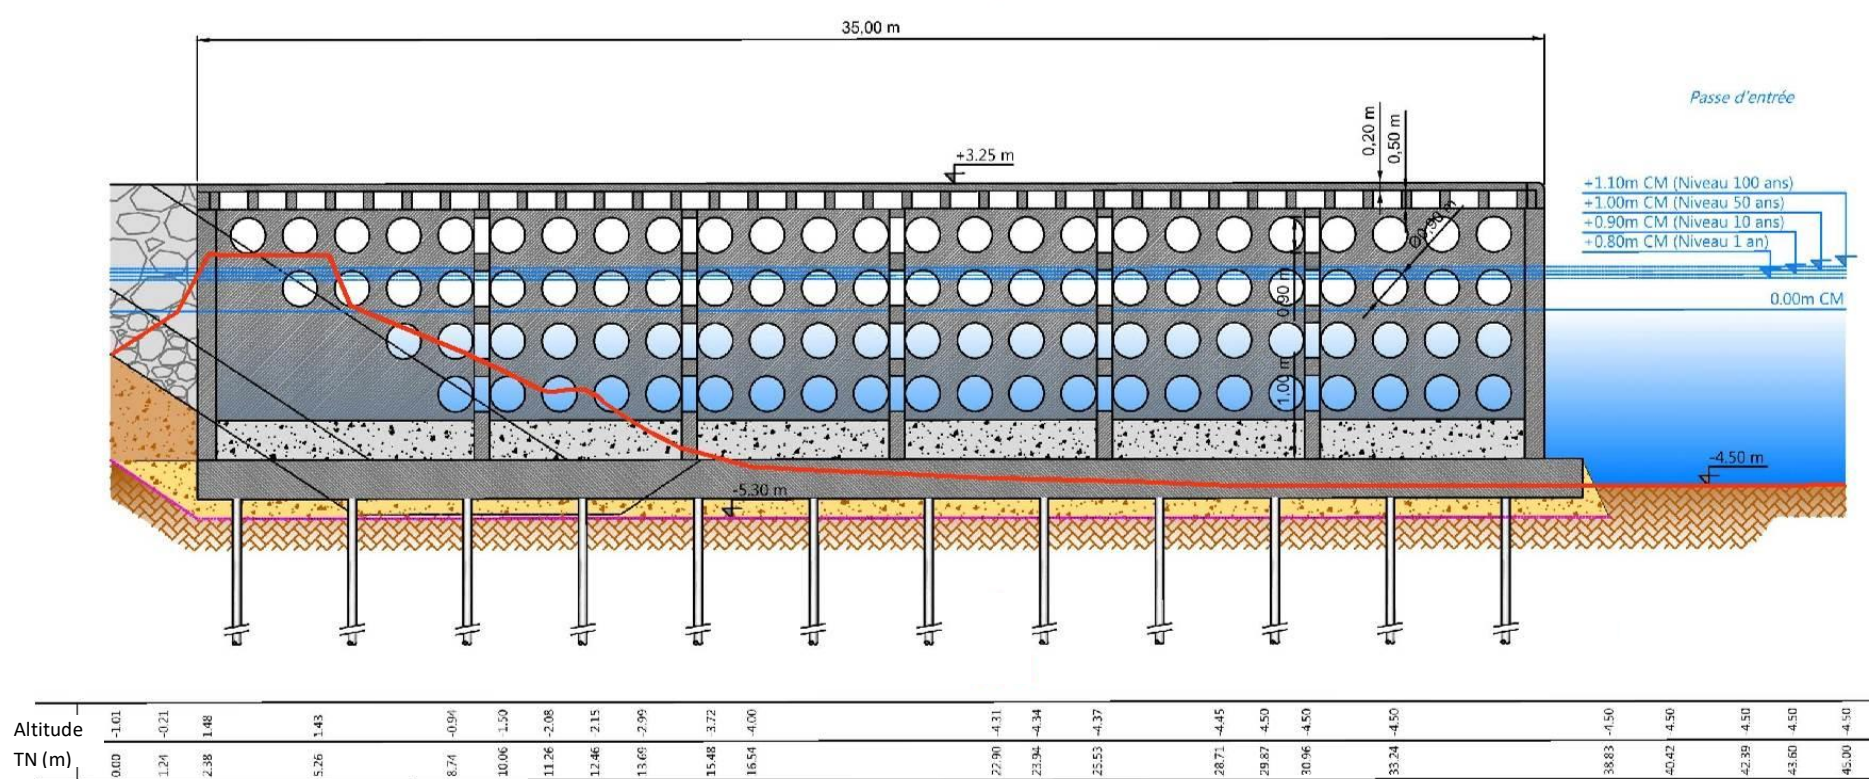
Tenon Ouest solution caissons Jarlan – Coupe 3 - — : Profil du terrain actuel
